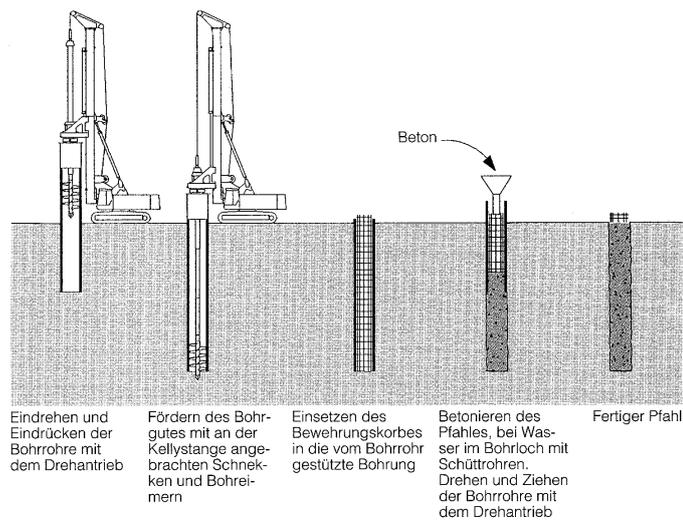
Drehbohrgerät mit Schnecke [14]
